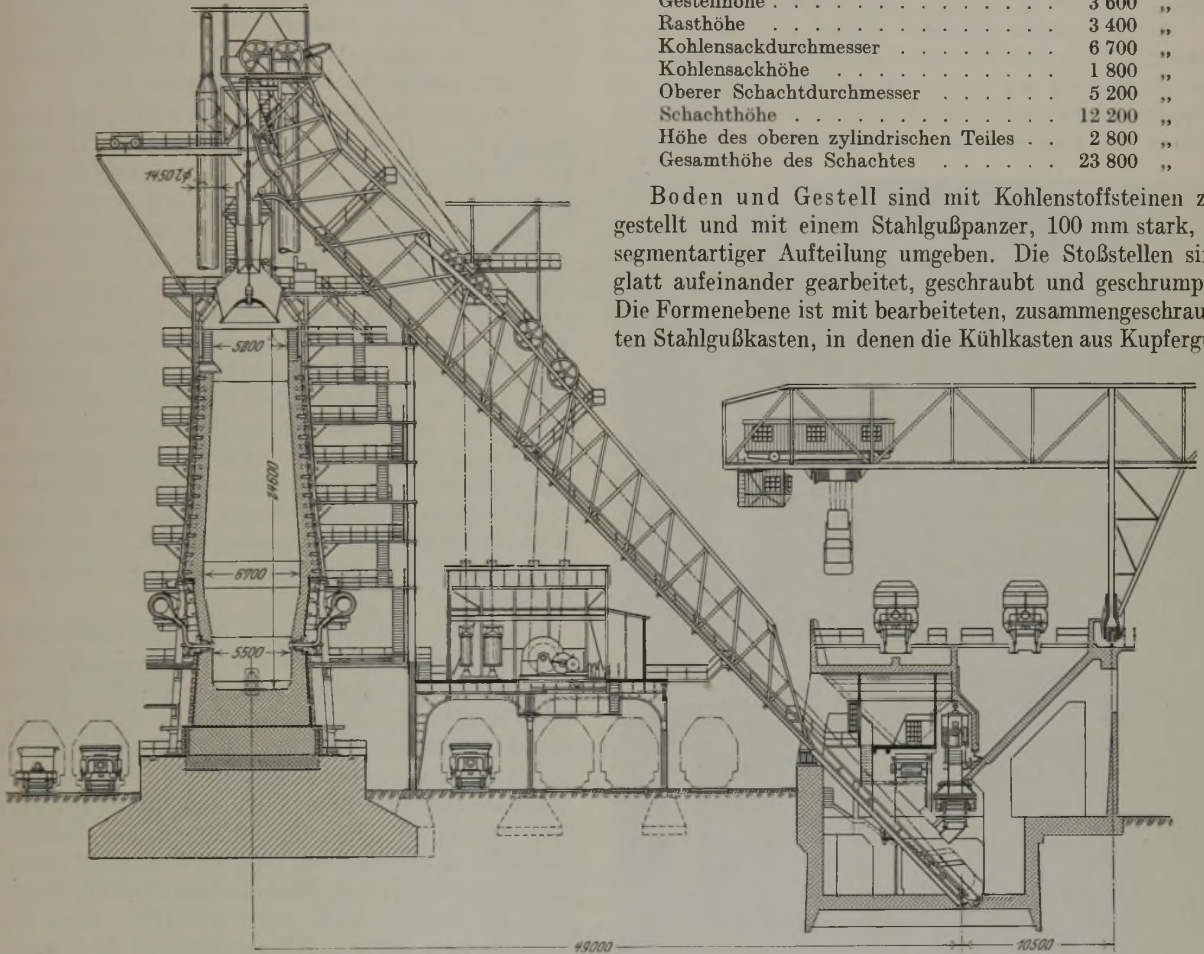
Hochofen mit Schrägaufzug und Bunkern.
